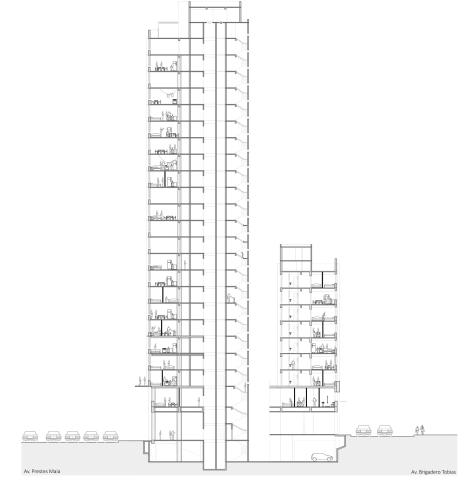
Corte Transversal edificio Prestes Maia Fuente: Elaboración propia
